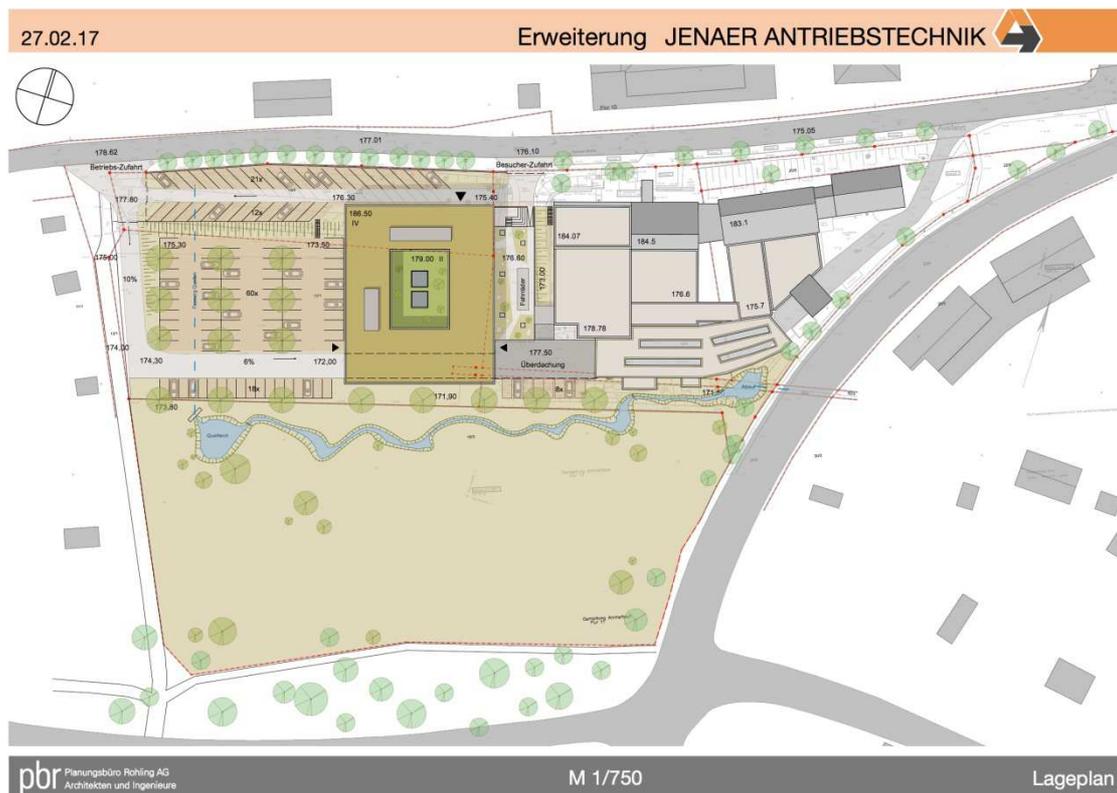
Variante 2.3 [finaler Stand, 27.02.2017] mit Neubaukörper um 90° gedreht [inhaltlich identisch mit Abb. 4]
